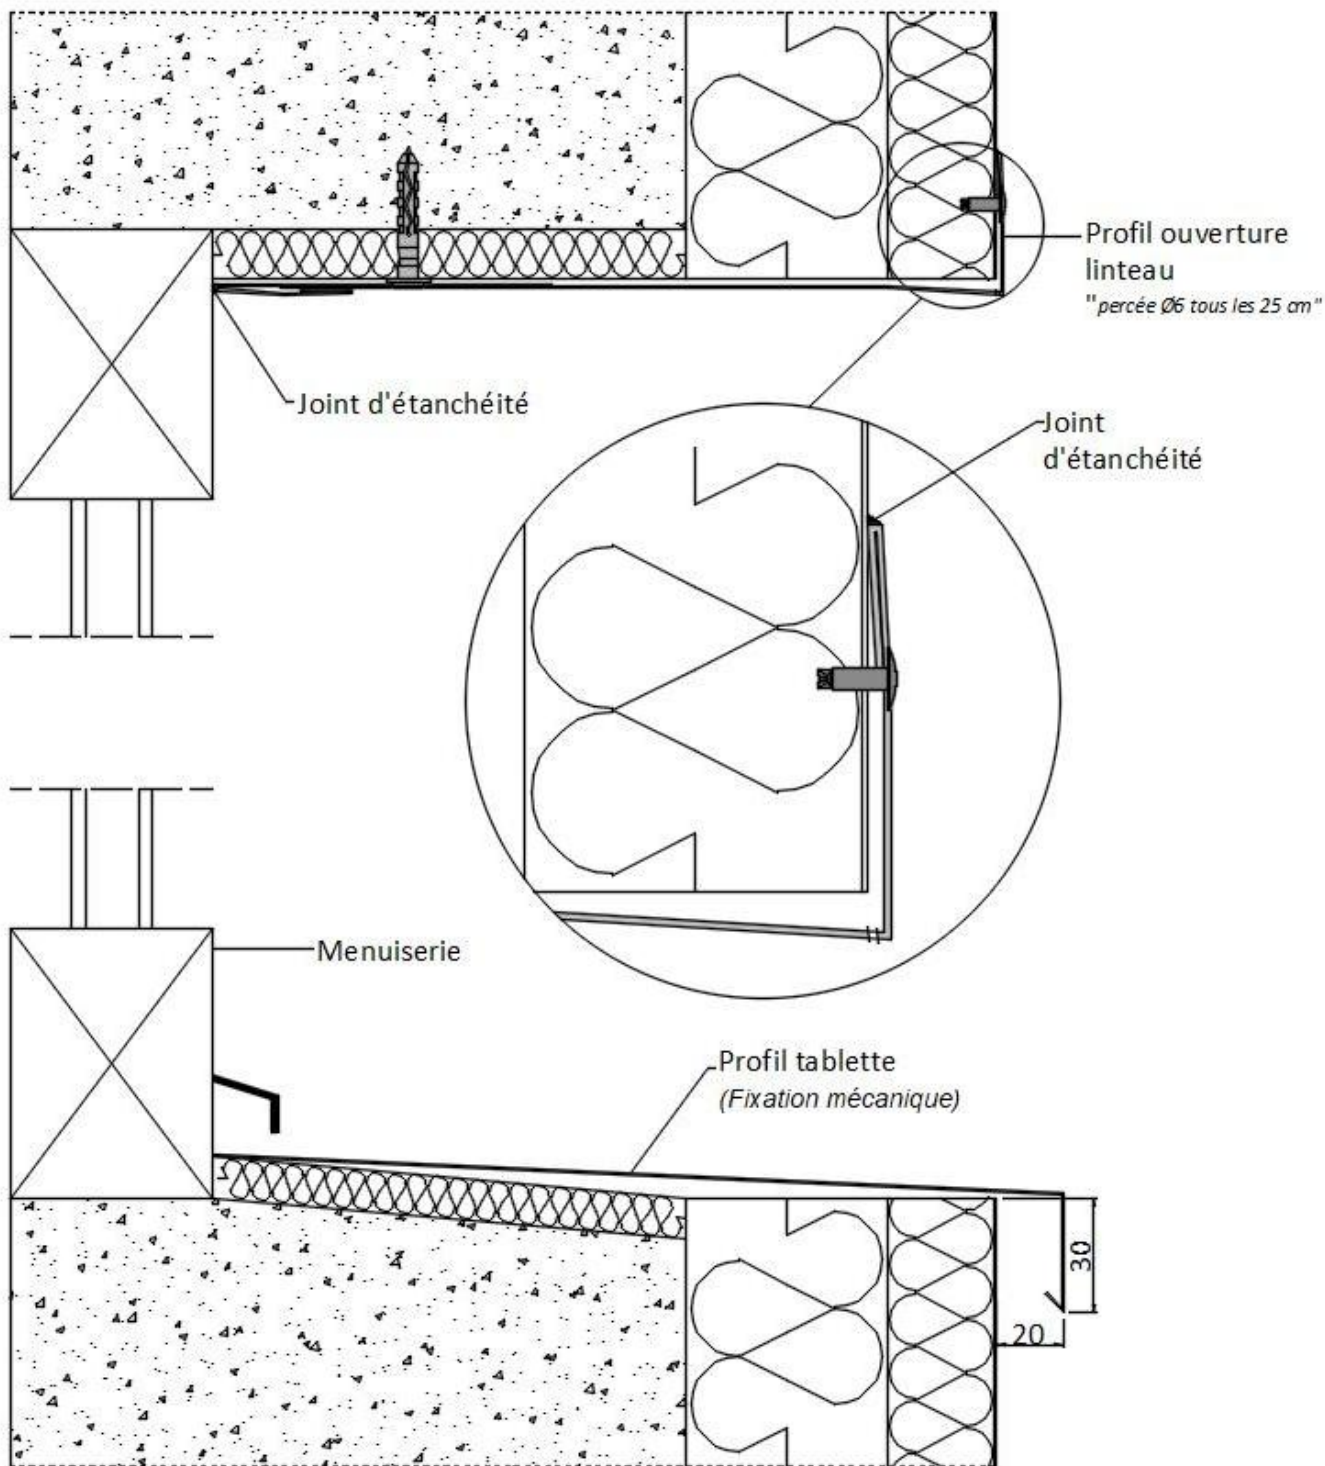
Habillage de fenêtre – Linteau et appui (coupe verticale)
